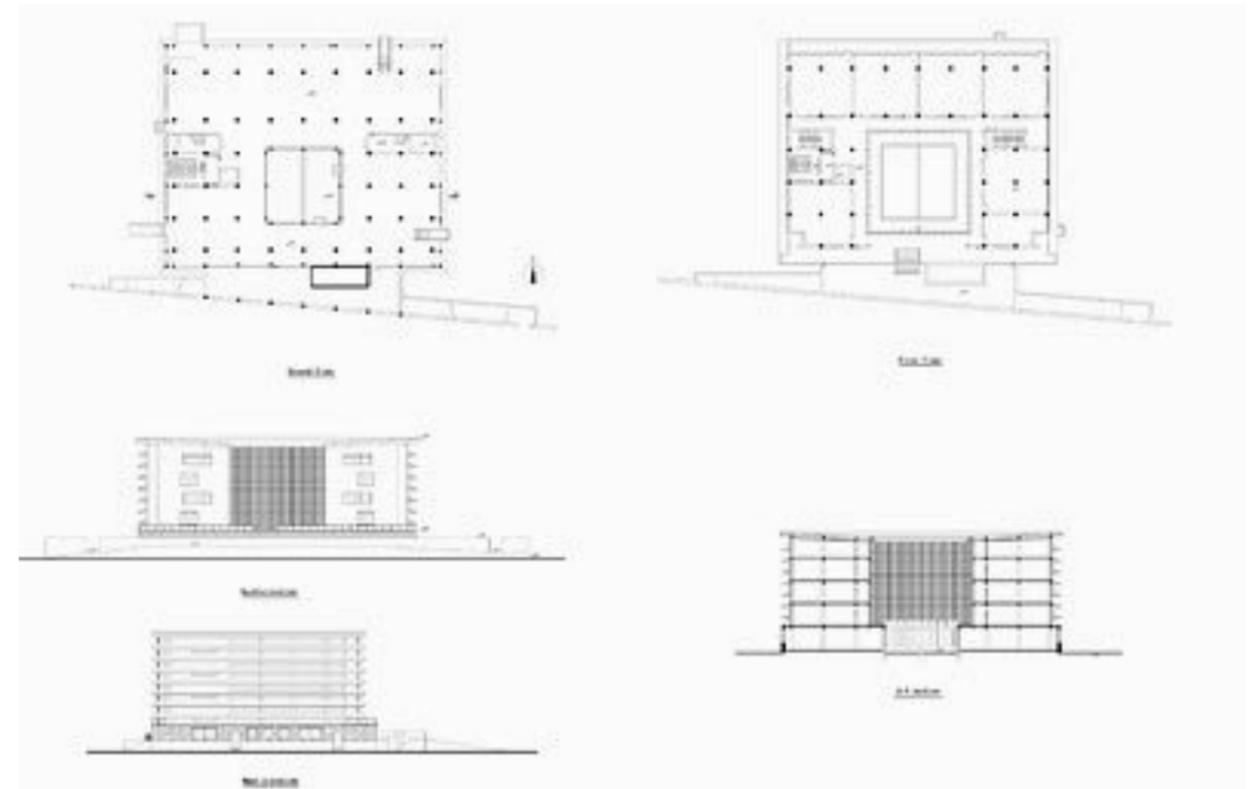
14. Planos del edificio 4: Academia + Talleres. (Imagen extraída en red: world-architects.com).
